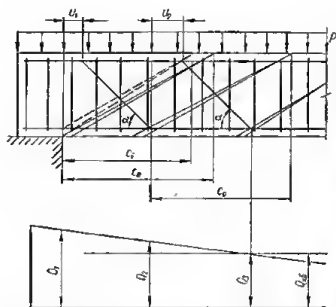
Наиболее опасные наклонные сечения в изгибаемом железобетонном элементе, армированном поперечными и отогнутыми стержнями.
